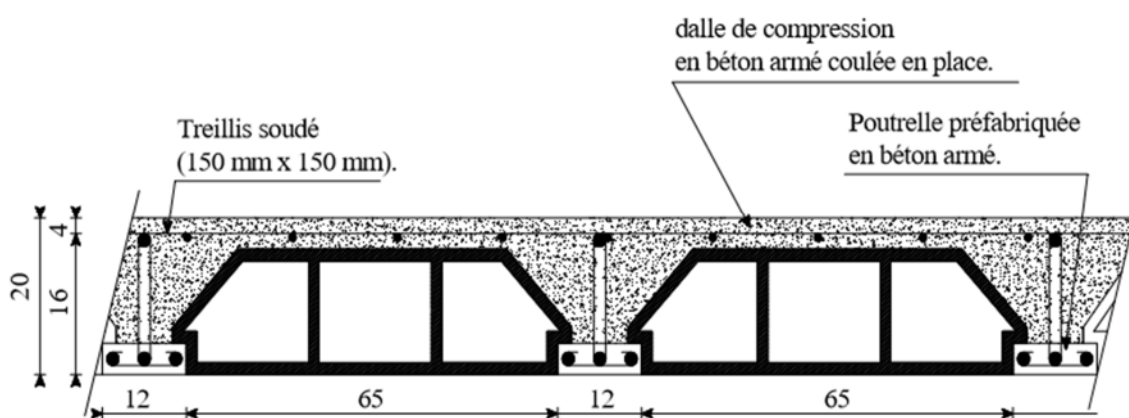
Coupe transversale d'un plancher à corps creux.
